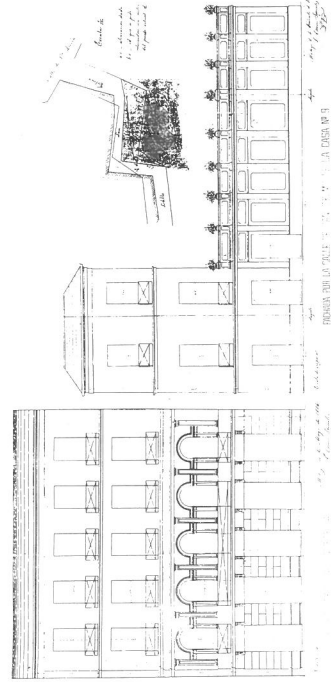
Proyecto de alzado para Pza. Constitución nº 9. Fachada a la Plaza y c/ S. Telmo, G. Cuervo, 1876; y de alineación en su fachada trasera, J. Rucoba, 1875.
